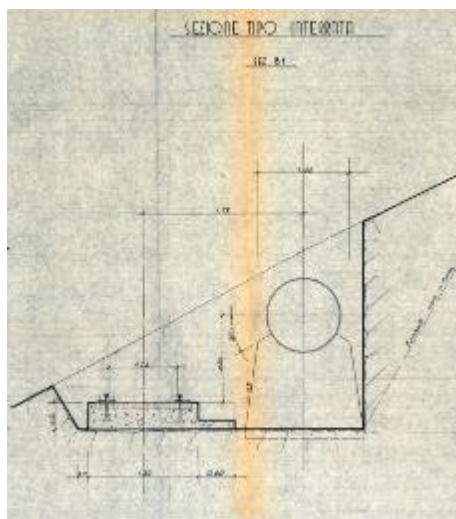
sezione tipo condotta e piano inclinato (anno 1956)
